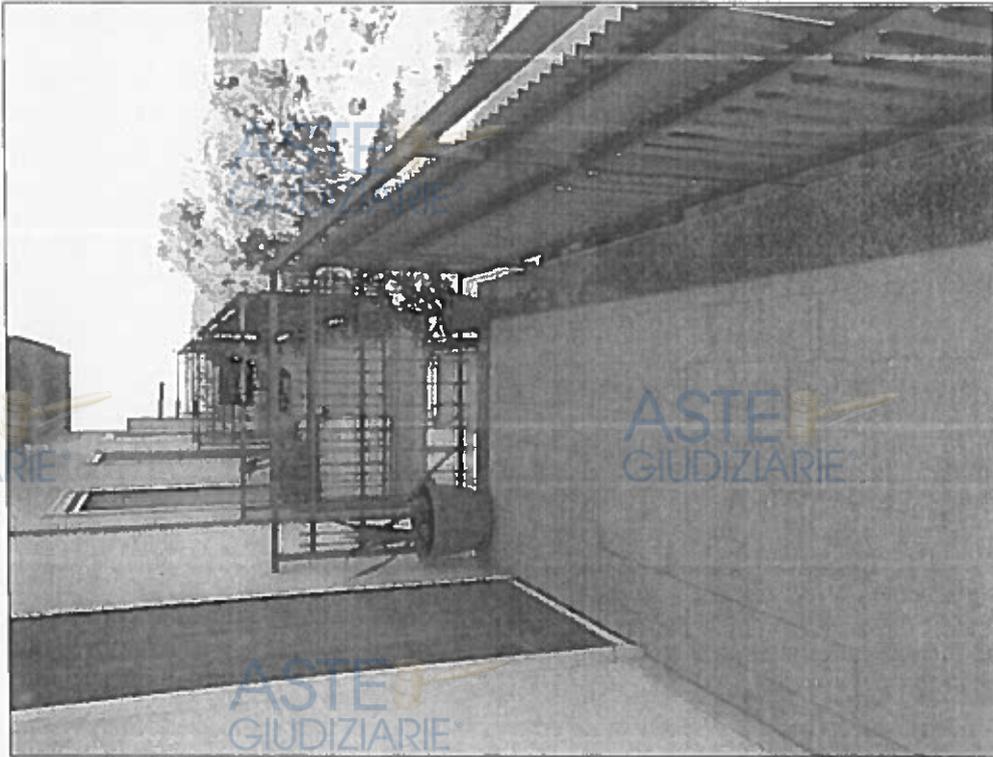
APPARTAMENTO SUB 2 - BALCONE SU SP31
